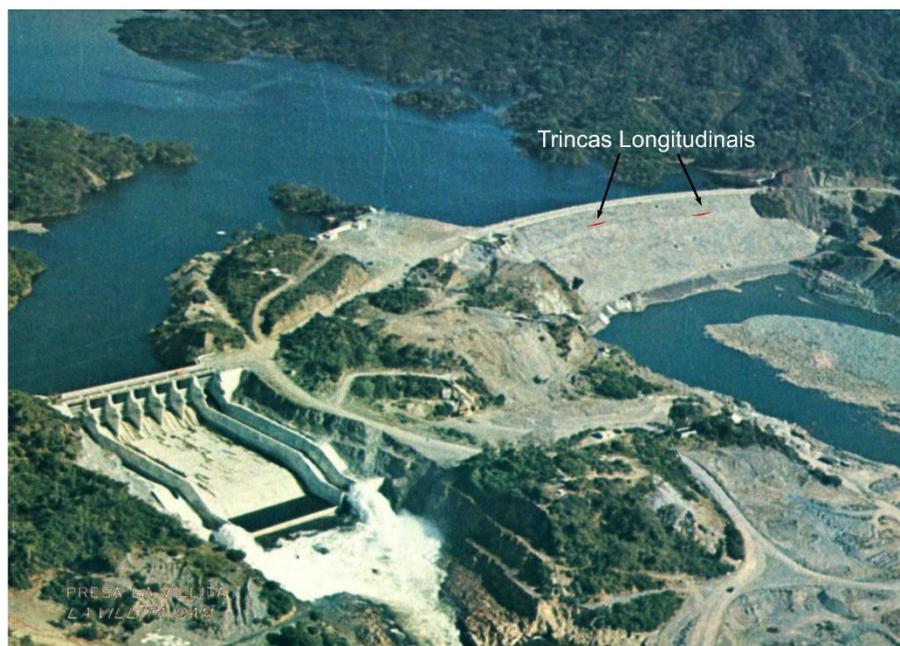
Fissuras longitudinais na barragem de El Infiernillo (México)
